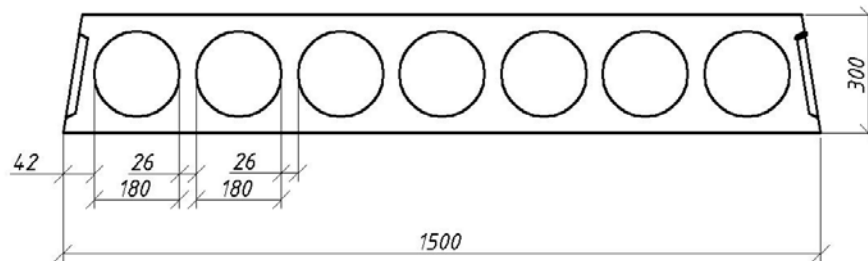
Компоновка пустотной плиты перекрытия
